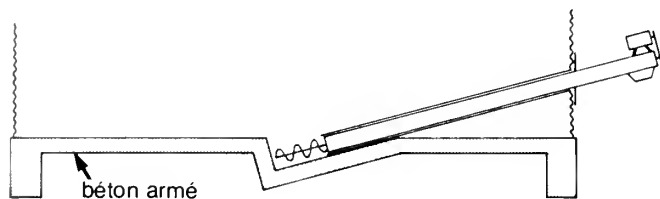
Fondations en béton pour entrepôt circulaire doté d'une vis inclinée à déchargement central
